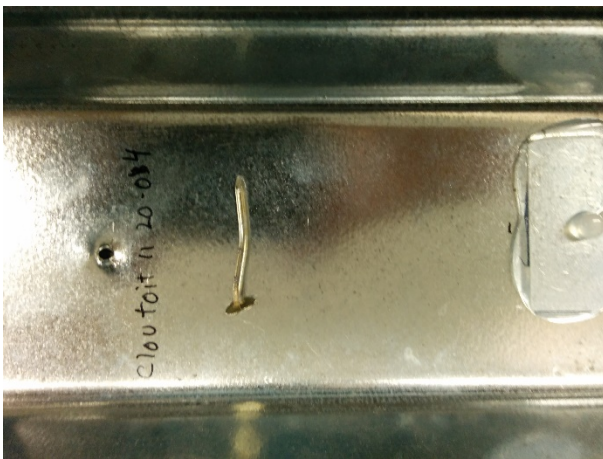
État du clou suite à la rupture de l'assemblage Clou toit #11 1-1/2-20-4
